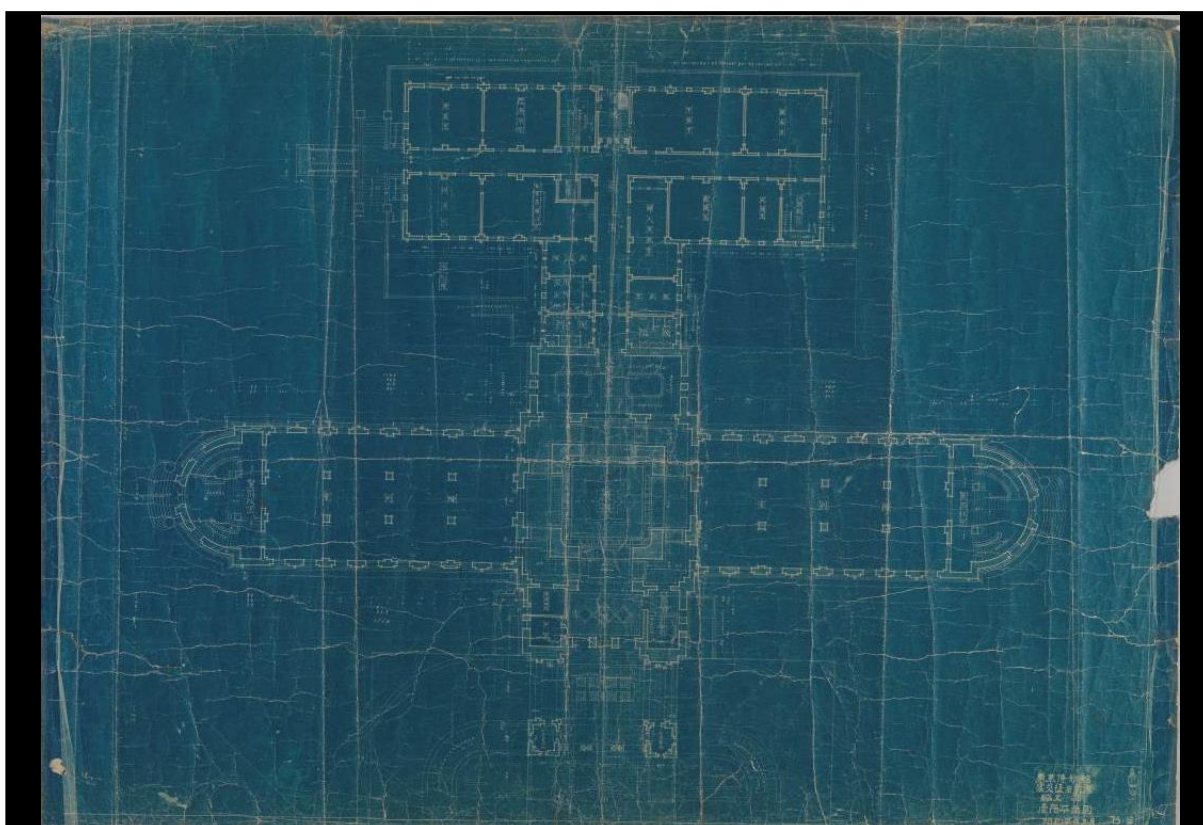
東京科学博物館震災復旧新営工事設計図（1階平面図）
